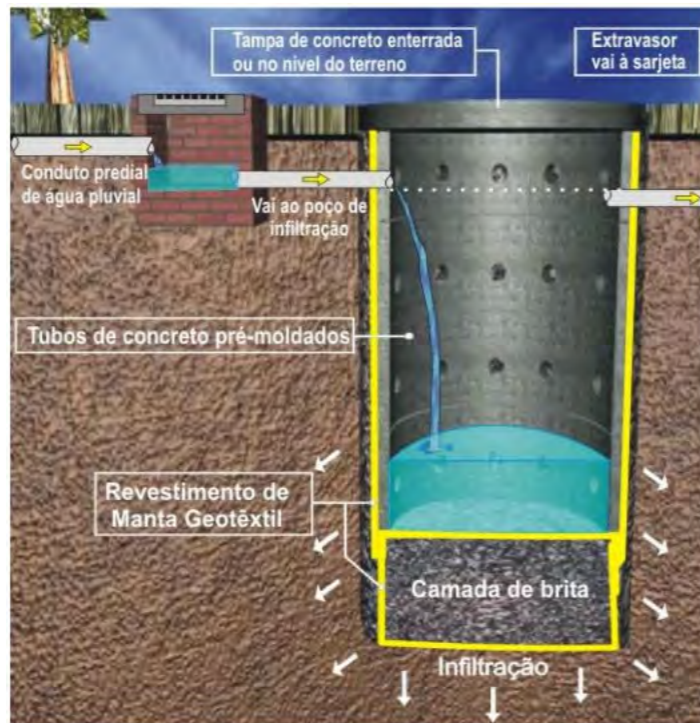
Corte esquemático de um poço de infiltração. Fonte: Reis, Oliveira e Sales (2008)
